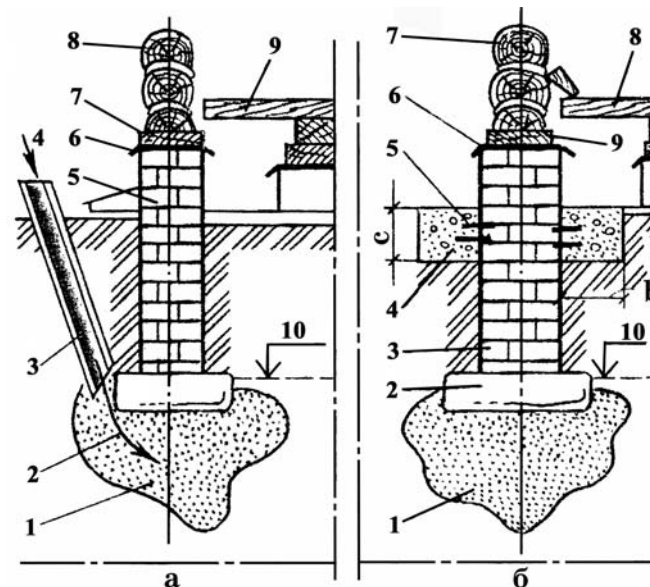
Укрепление основания фундамента: а — бетонным раствором: 1 — грунт, насыщенный бетонным раствором; 2 — направление заполнения раствором основания фундамента; 3 — труба для подачи раствора; 4 — залив раствора; 5 — столбчатый кирпичный фундамент; 6 — гидроизоляция; 7 — деревянная подкладка; 8 — бревна; 9 — пол; 10 — первоначальная отметка подошвы фундамента; б — бетонным кольцом: 1 — грунт, насыщенный бетонным раствором; 2 — постелистый камень; 3 — столбчатый кирпичный фундамент; 4 — железобетонное кольцо; 5 — металлические штыри; 6 — гидроизоляция; 7 — бревна; 8 — пол; 9 — деревянная подкладка; 10 — первоначальная отметка подошвы фундамента; b, с — размеры по месту.
